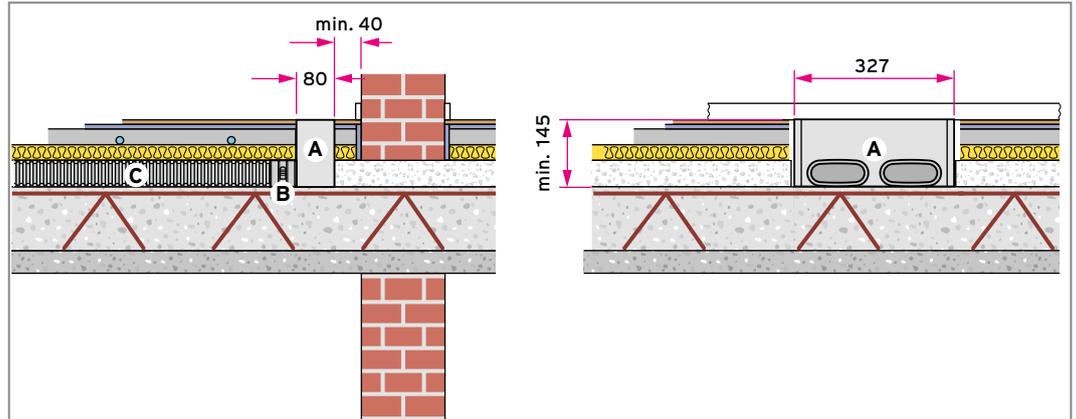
Rechteckiger Luftauslass, Bodenmontage - Verlegung im Fußbodenaufbau
